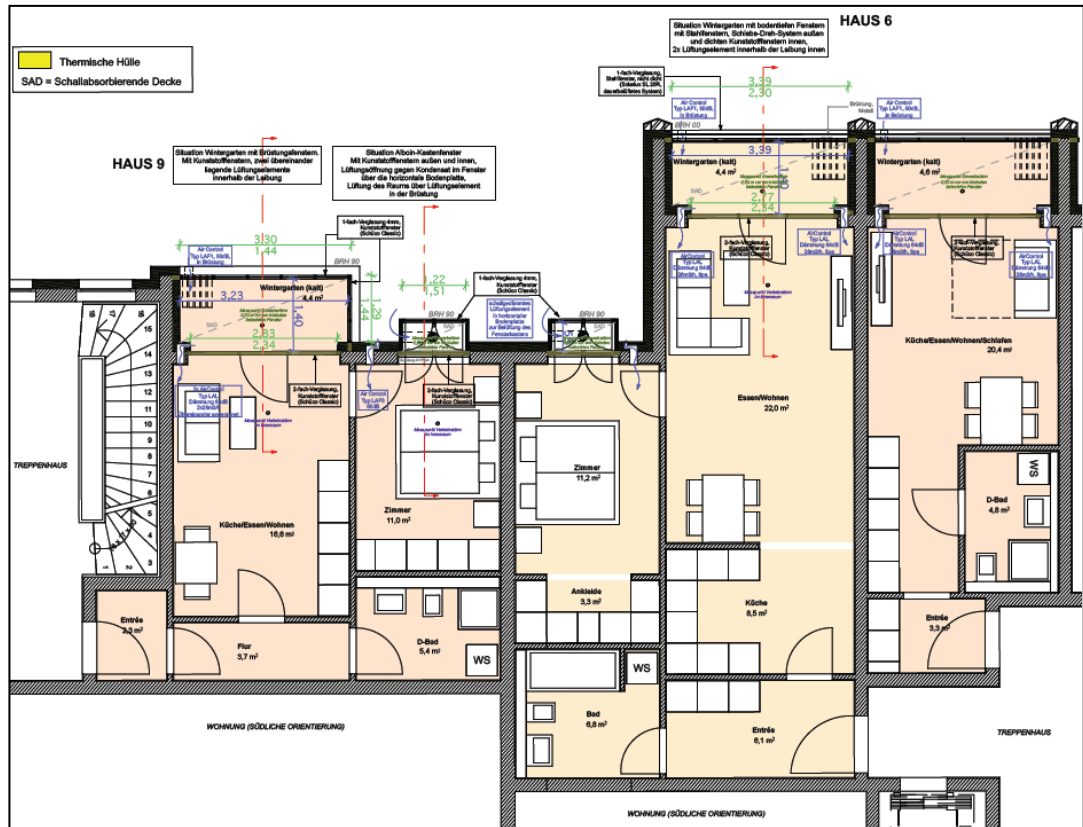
Grundrissdetail Haus 6 und 9, Stephan Hoehne Architekten
